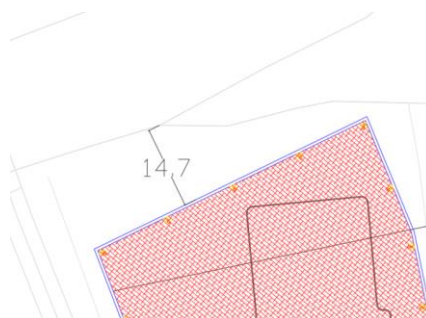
Stralcio Planimetrico – distanza minima incisione-piazzale di progetto
